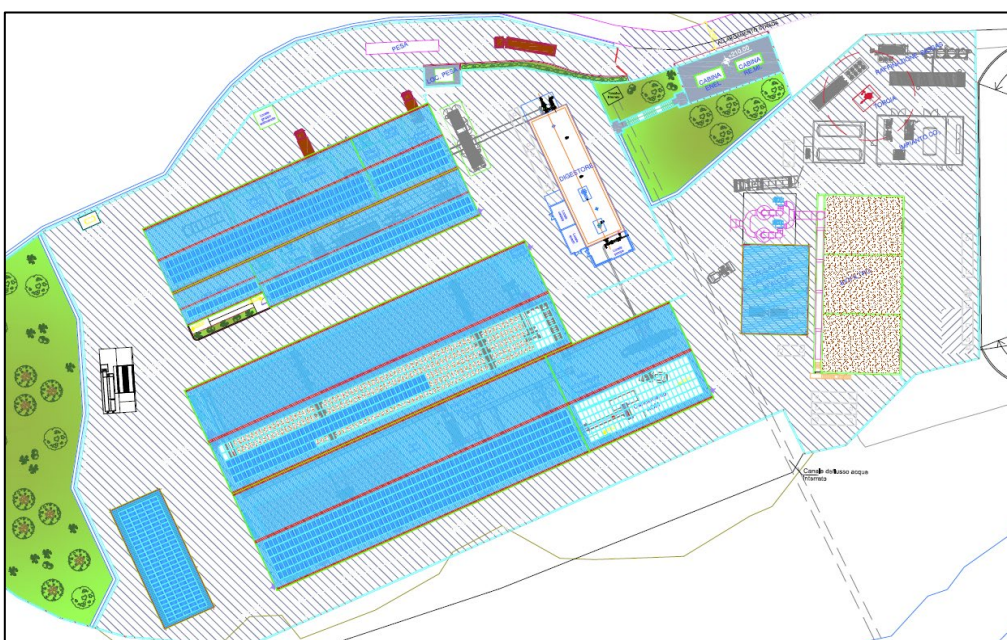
Stralcio planimetrico con indicazione delle aree delle coperture
